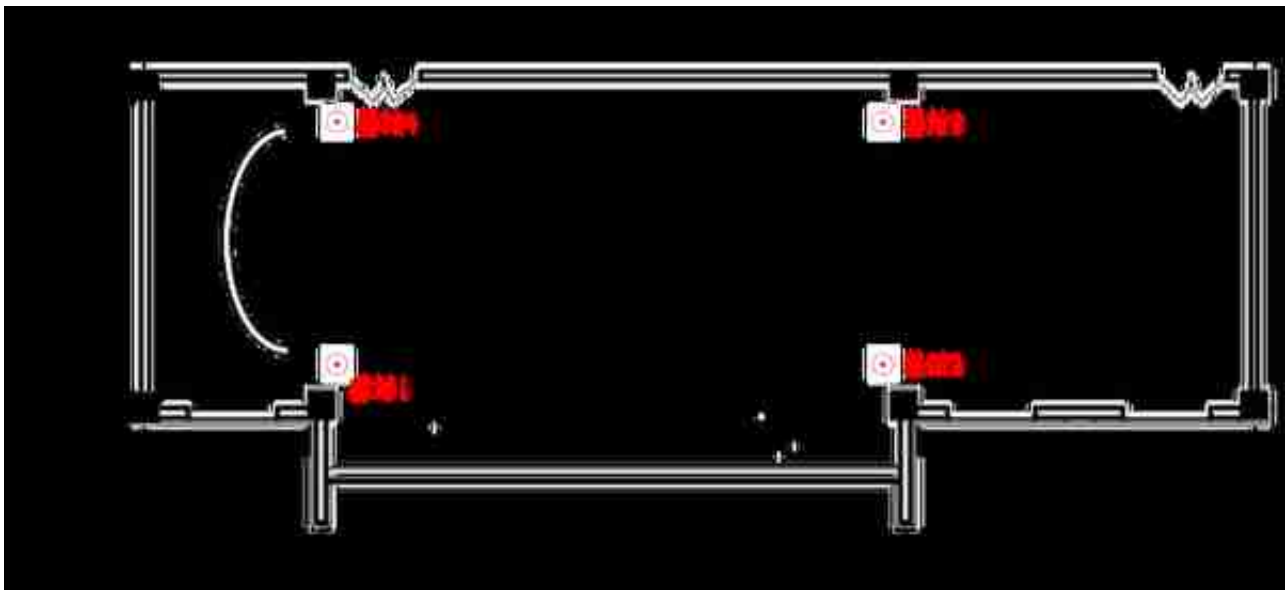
实验环境（展厅）及Wi-Fi RTT基站位置平面图
